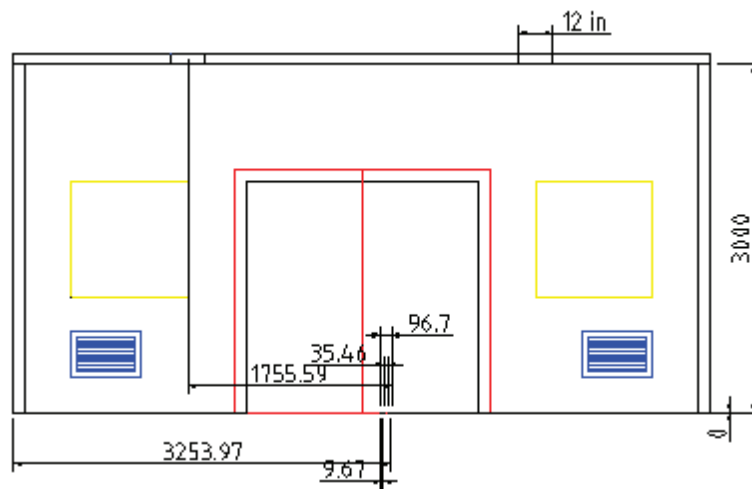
Vista frontal del sistema de encapsulamiento de la cabina de molinos
